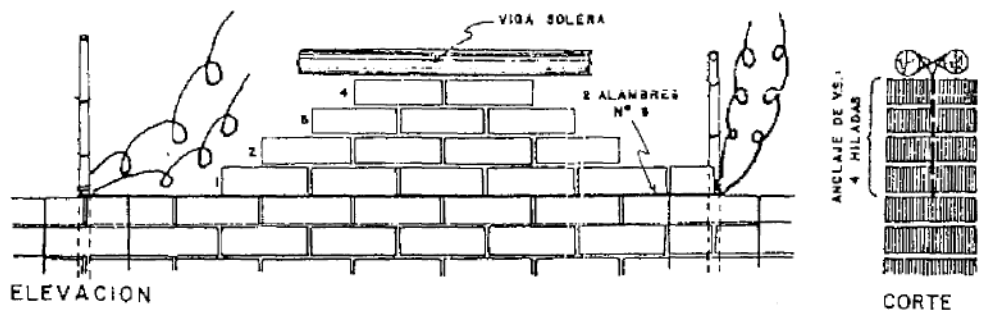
ANCLAJE DE VIGA SOLERA CON LOS MUROS
